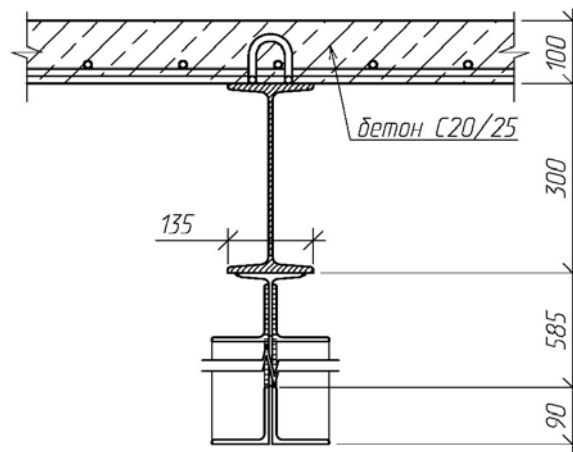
Переріз шпренгельної сталезалізобетонної конструкції перекриття після бетонування, прольотом 10 м.
